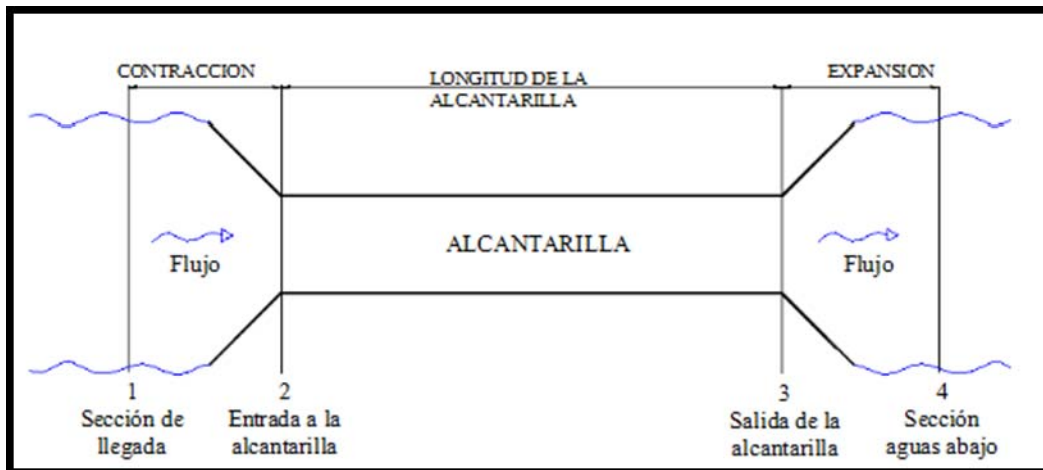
Vista en planta de una alcantarilla y secciones de control. (IMFIA & MTOP, 2000)
